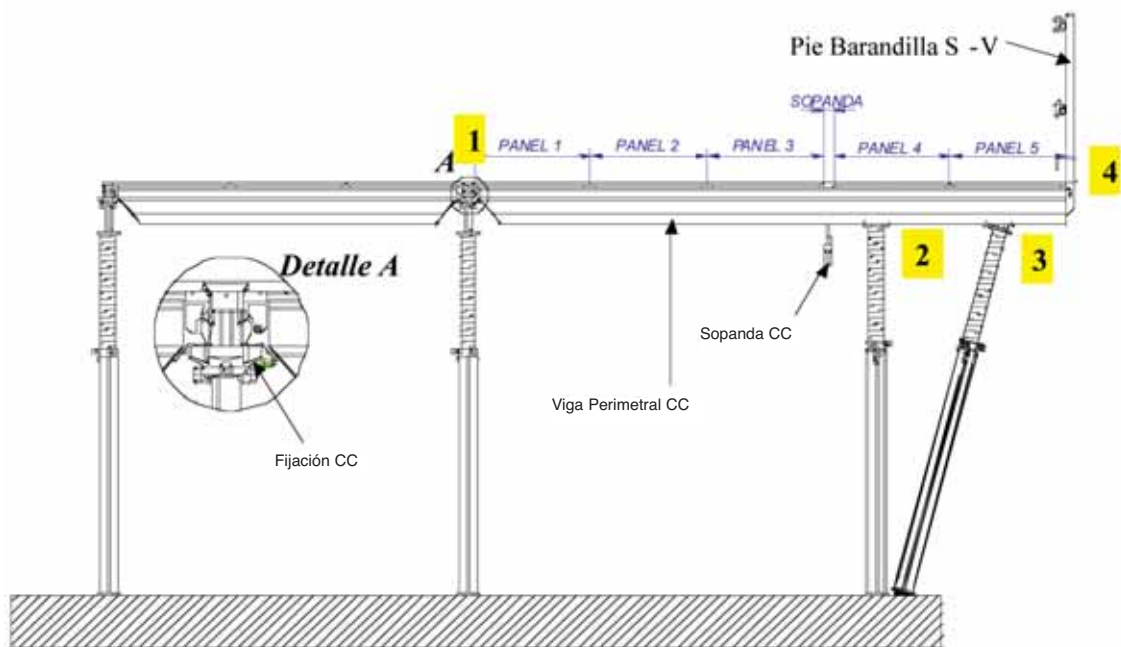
VIGAS PERIMETRALES CC en la dirección de las VIGAS CC
